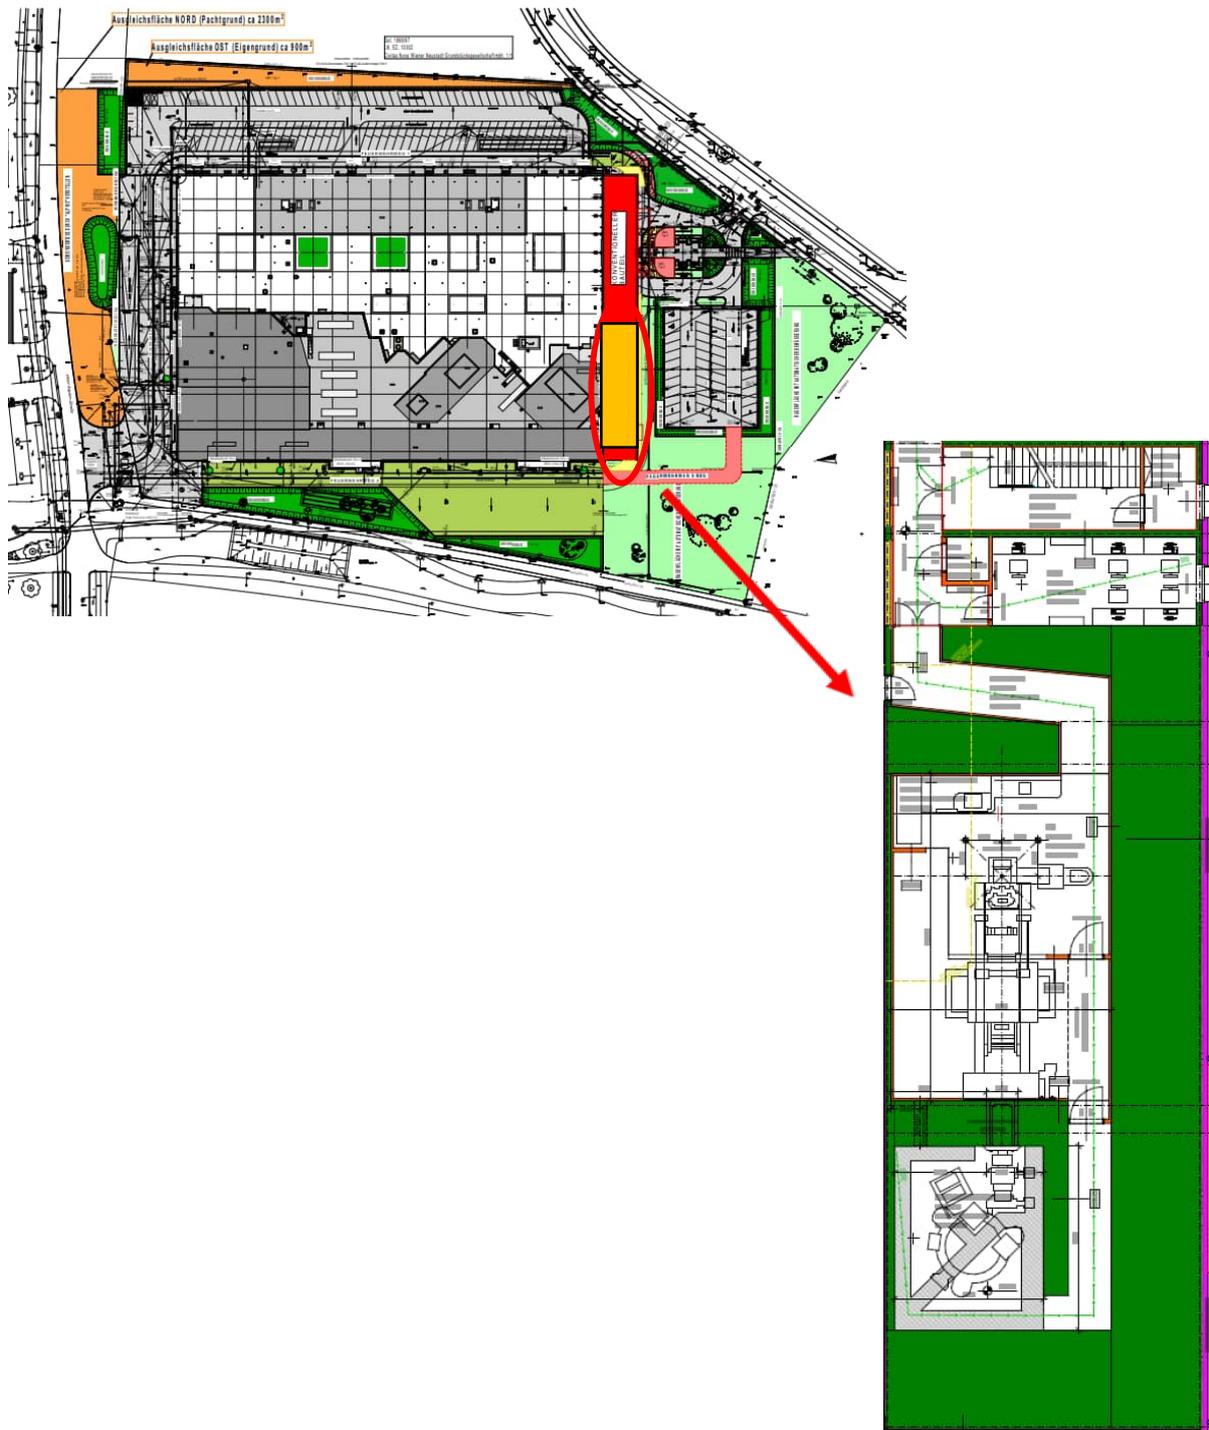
Im Anschluss an den Bunkerbereich des Bestandsgebäudes befindet sich der Bunkerbauteil mit den sichtbaren dicken Strahlenschutzwänden. Details können dem Plan „B.03-01 P01 2.0 A Grundriss Erdgeschoss“ entnommen werden.
